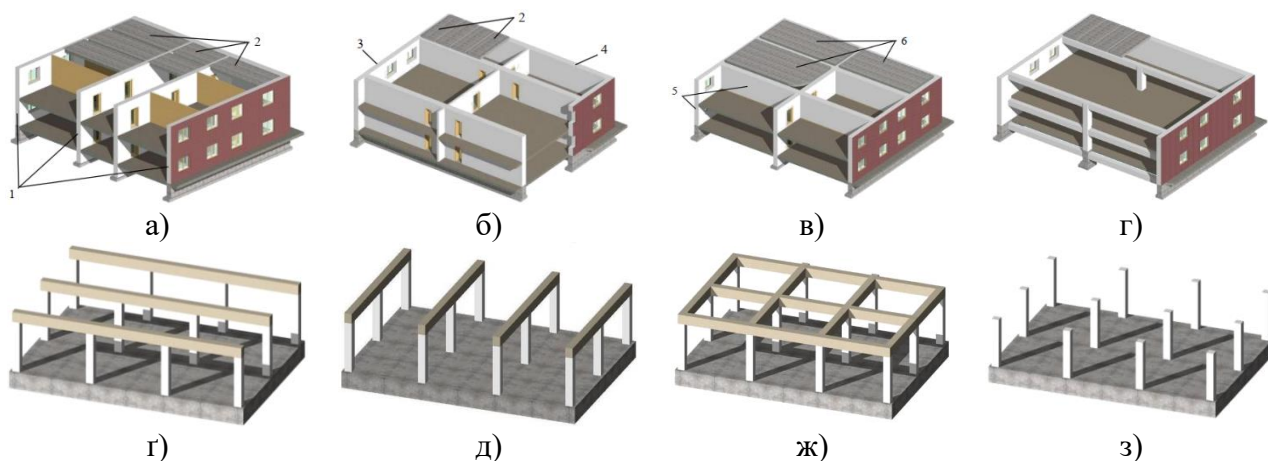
Конструктивні схеми будівель: а – безкаркасна з позовжнім розташуванням несучих стін; б – безкаркасна з поперечним розташуванням несучих стін; в – безкаркасна з перехресним розташуванням несучих стін; г – з неповним каркасом при поперечному розташуванні ригелів; г) – повнокаркасна з позовжнім розташуванням ригелів; д – повнокаркасна з поперечним розташуванням ригелів; ж – повнокаркасна з перехресним розташуванням ригелів; з – повнокаркасна безригельна; 1 – зовнішня та внутрішня стіни; 2 – панелі міжповерхових перекриттів; 3 – самонесучі зовнішні стіни; 4 – несуча стіна торця; 5 – несучі стіни (повздовжні та поперечні); 6 – плита перекриття, оберта по контуру
